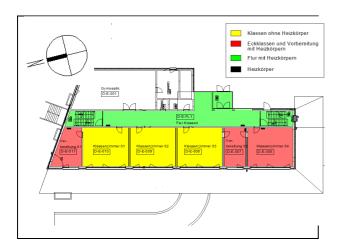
Grundriss EG mit Zonierung (Variante 2)
